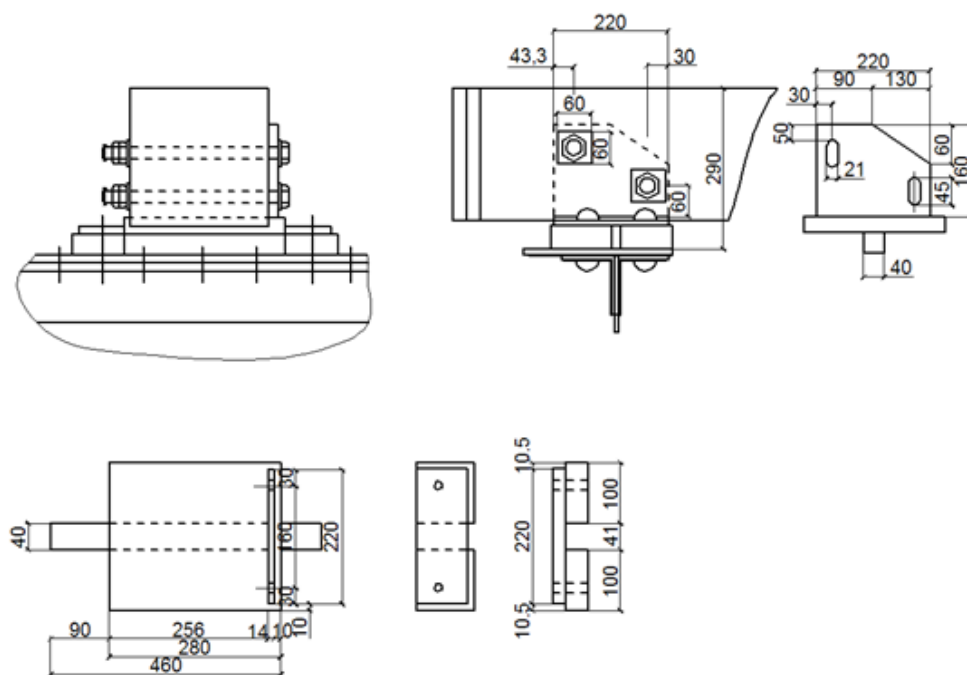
Прикрепление сваркой центрирующей планки к "L"-образному элементу
